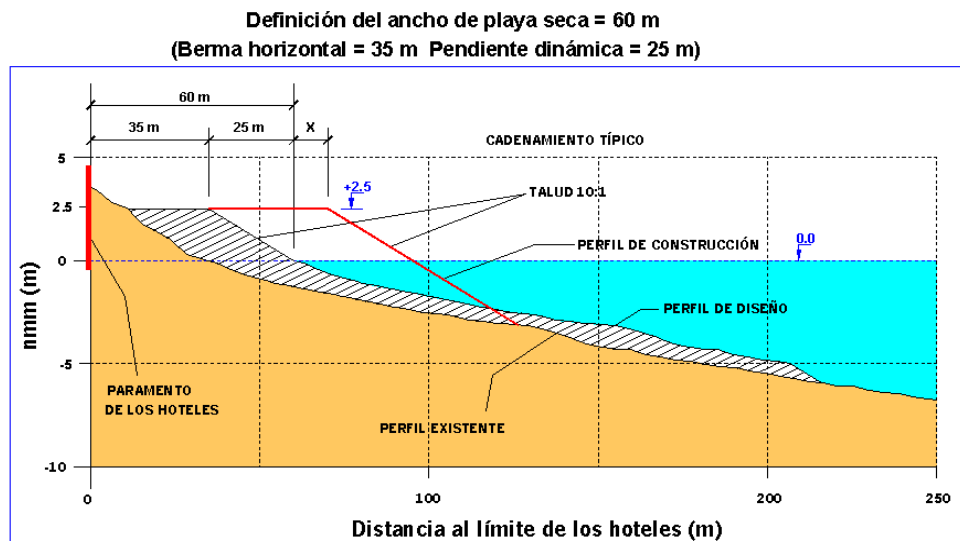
Perfil de construcción y perfil de proyecto en una sección tipo
